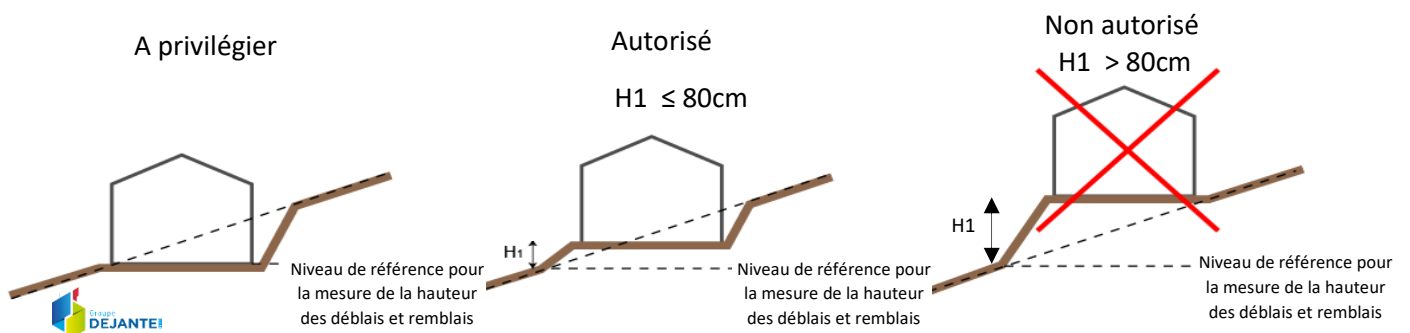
Règle générale pour l'implantation des constructions en zone 1AU
